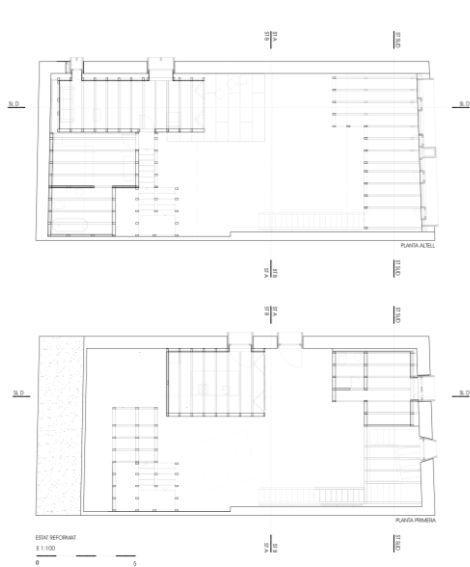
Planta 1 i planta 2 del Cine Lidia Font: autors
